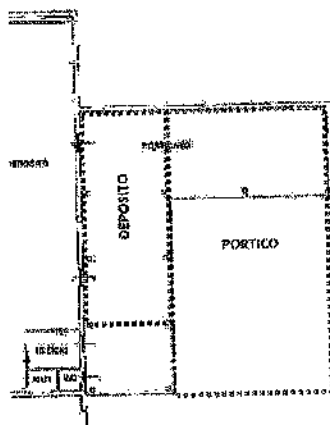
Stralzo planimetrico con schematizzata la diversa configurazione del portico
